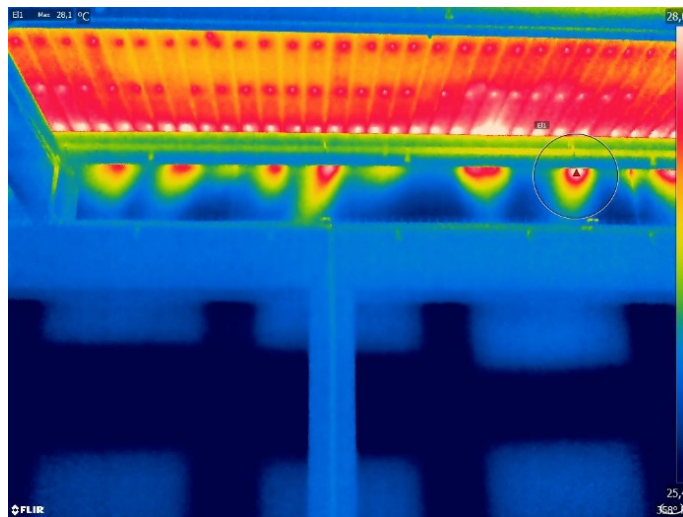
Entradas de aire en el encuentro de la cubierta con la fachada.
